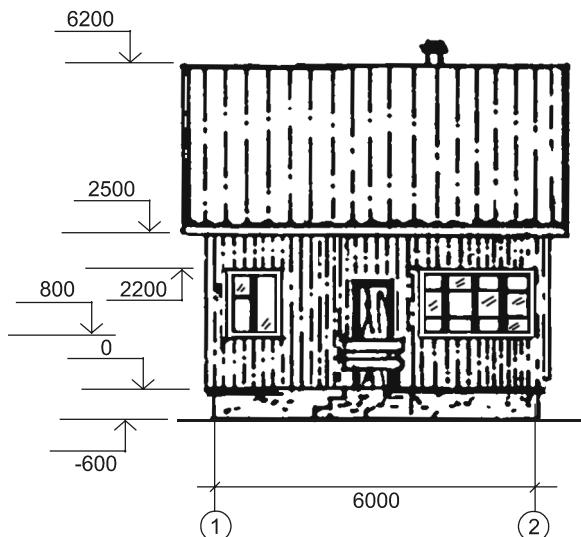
Боковой фасад двухкомнатного каркасного дома с мансардой. Вариант II
